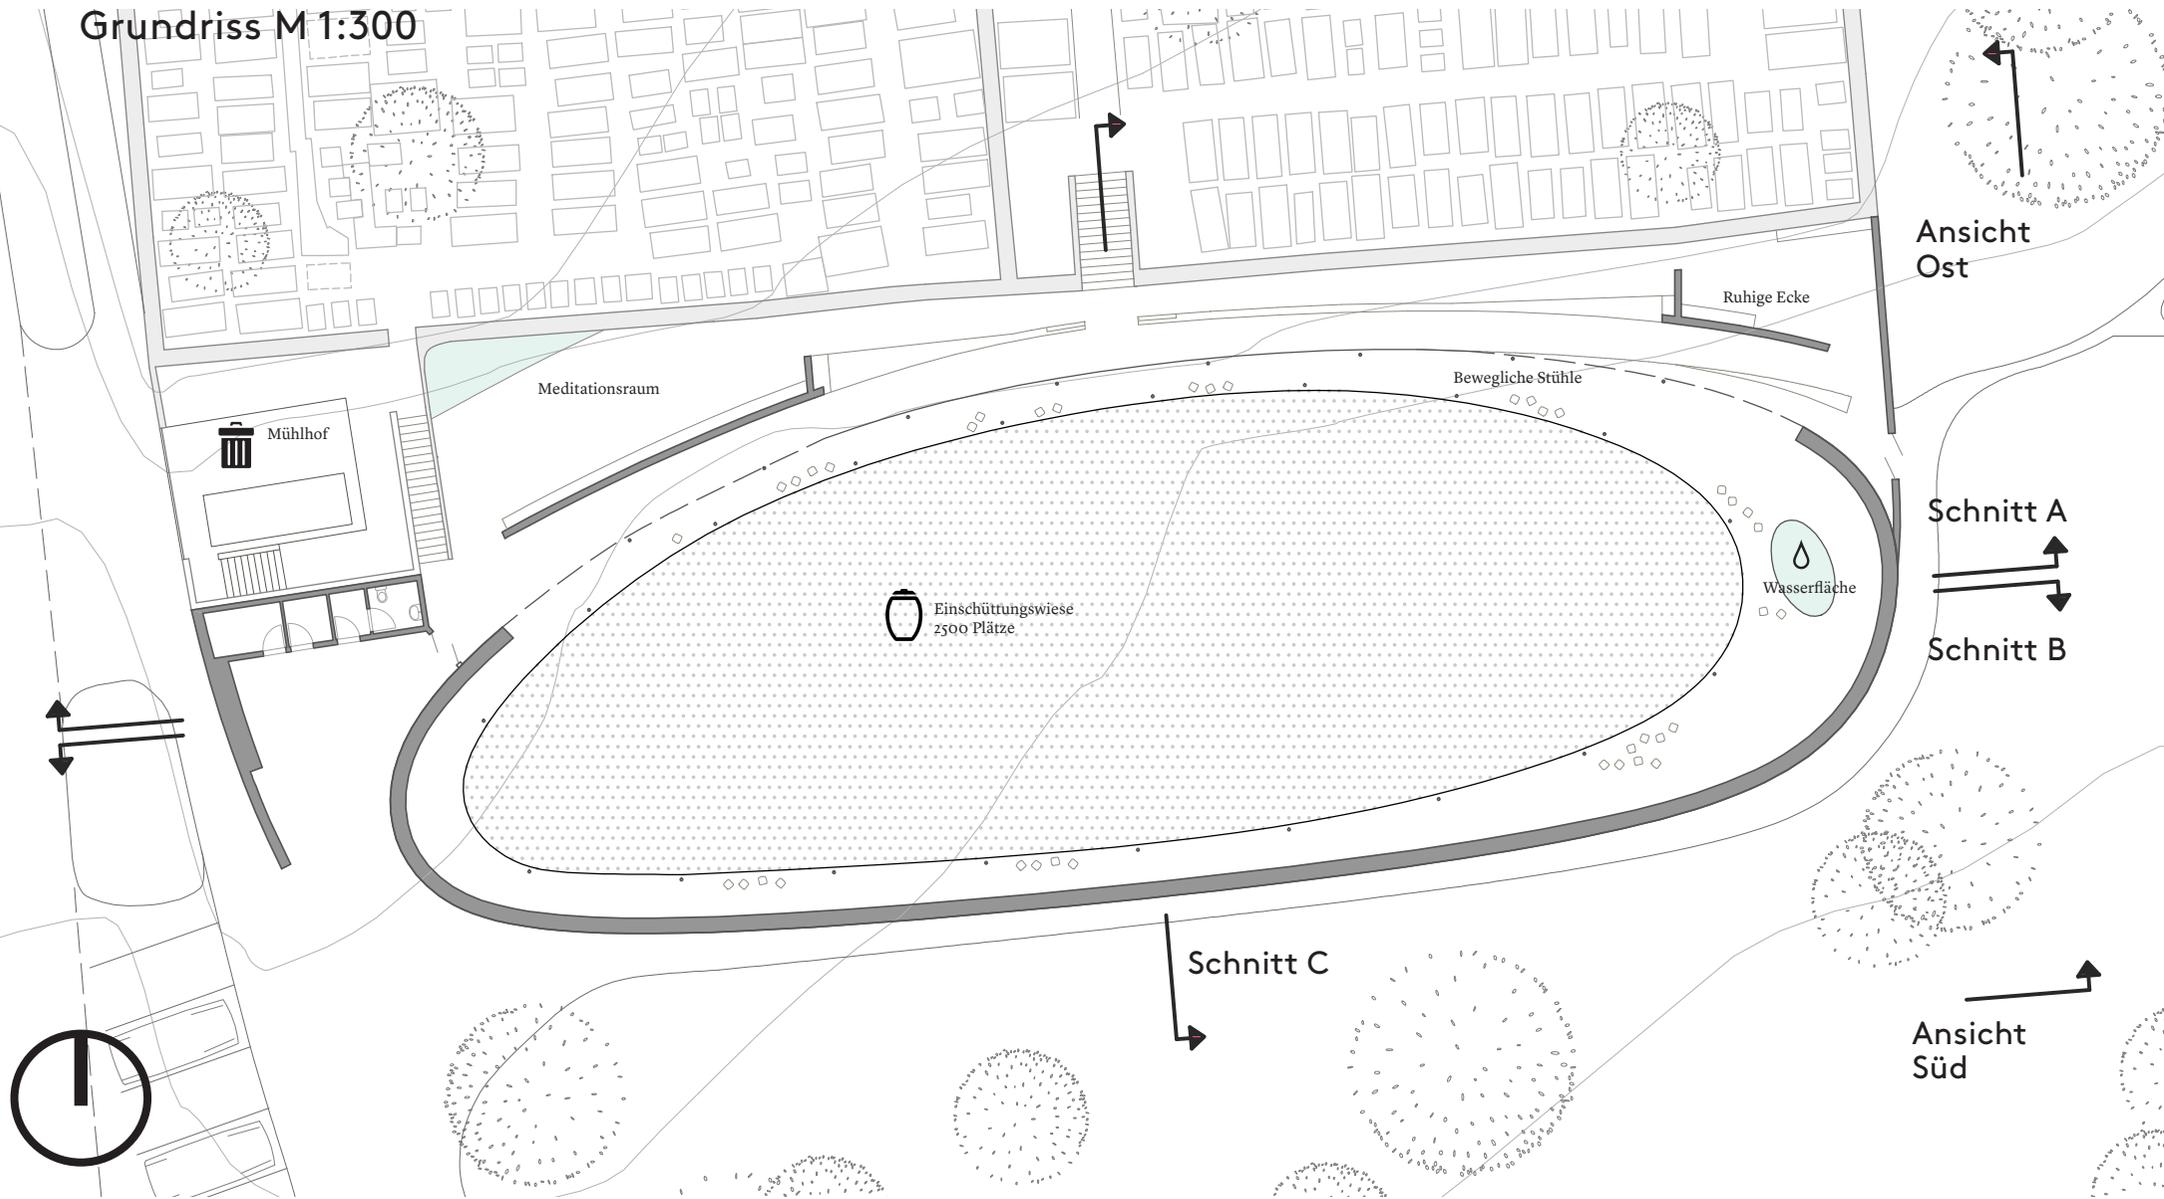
Friedhof Hostivař Grundriss M 1:300 (Táňa Kubiková 2017)
